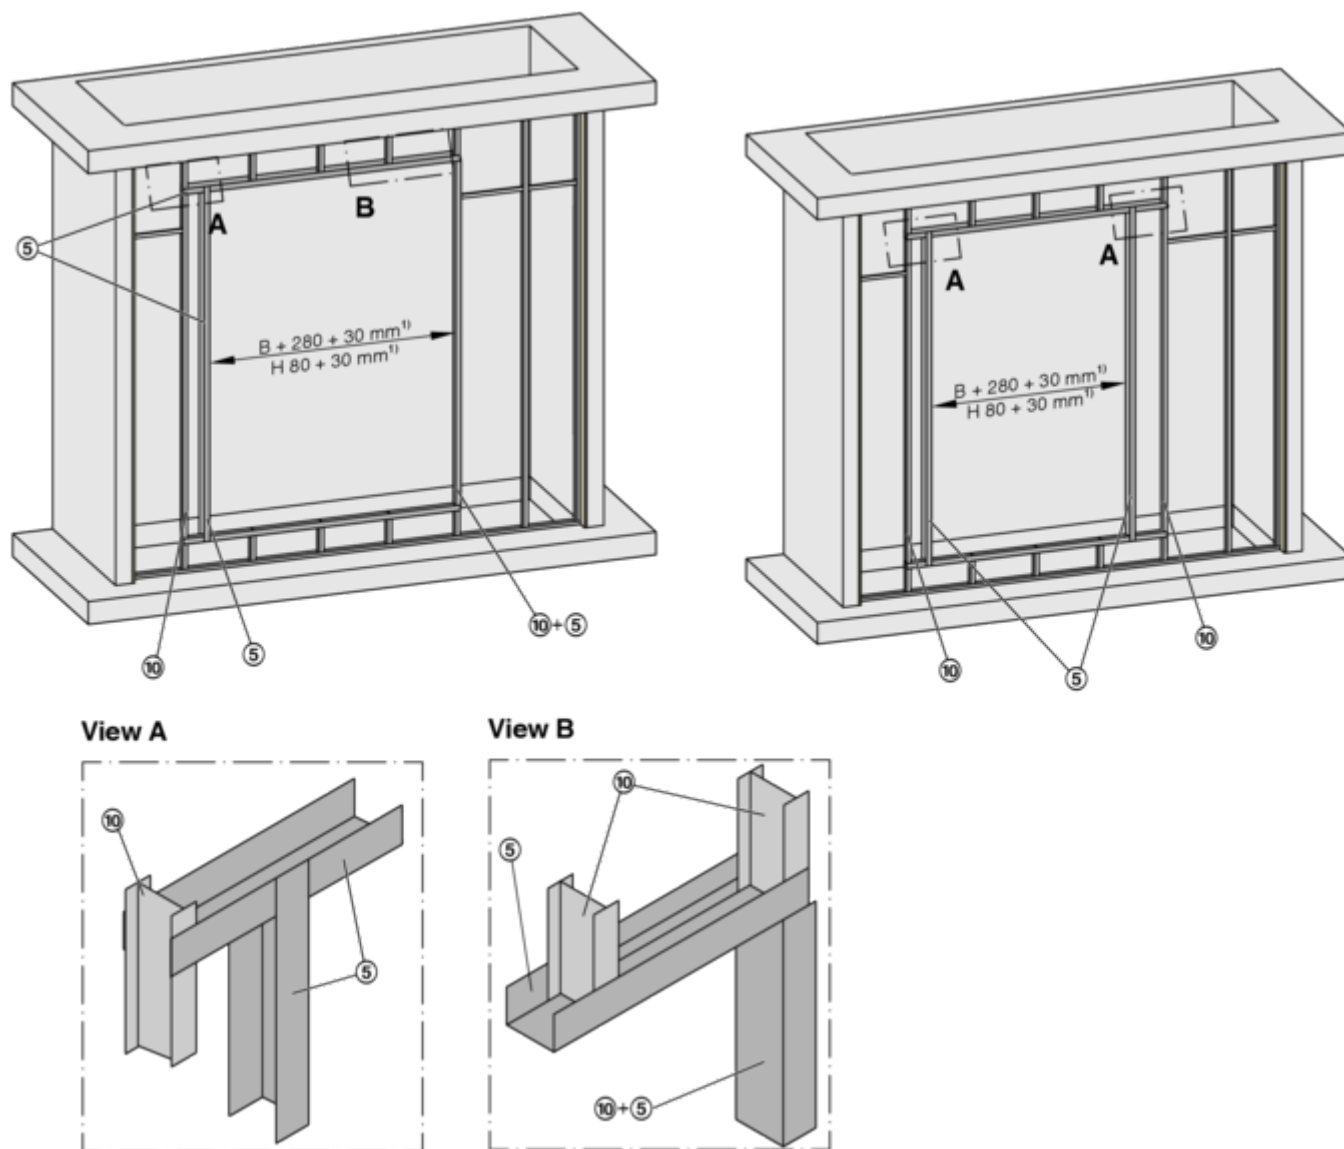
Inbouwvoorbeeld EK-JZ droge inbouw in systeemwand (alleen Gypsum) met enkelzijdige beplating EI 120 S
